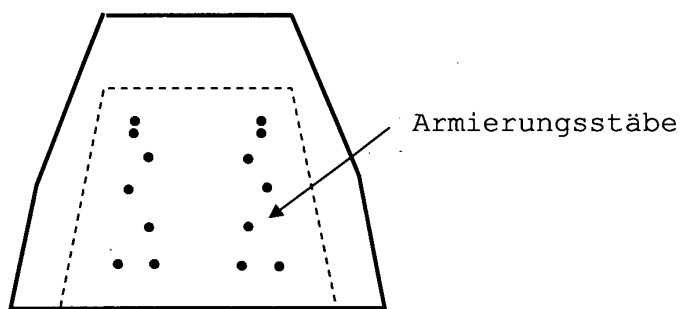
Betonschwelle mit Armierung, Querschnitt
